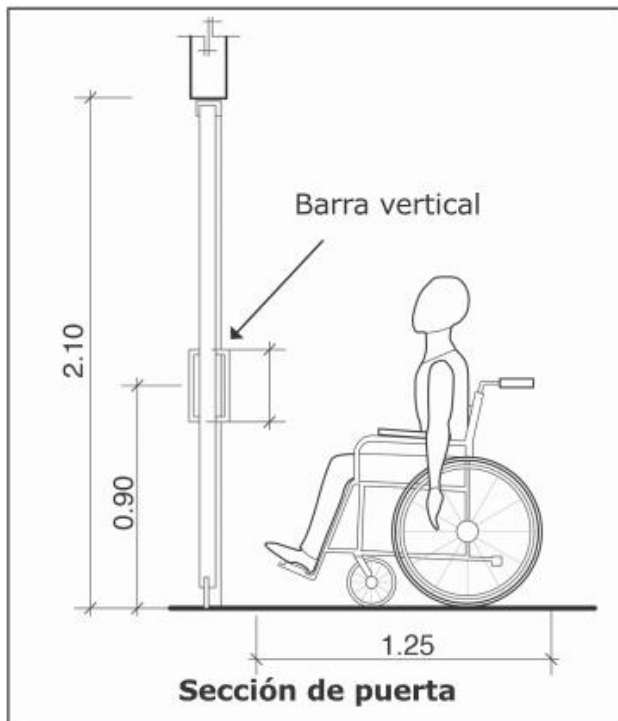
detalle de puerta elaborado por: CREAMQUITECTURA, Manual técnico de discapacidad
